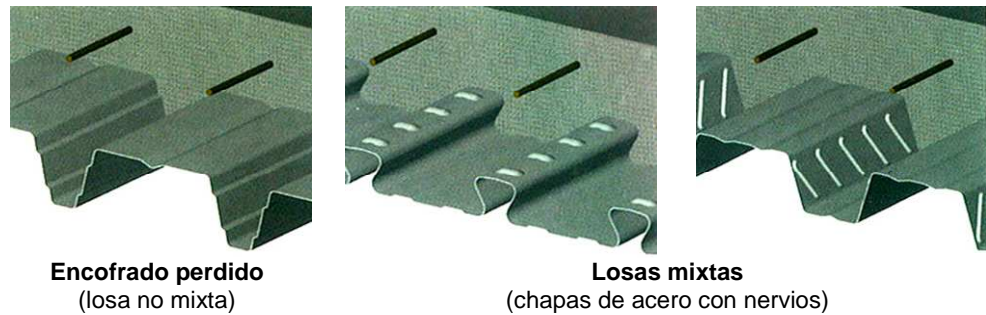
Losa de hormigón encofrado colaborante de acero
